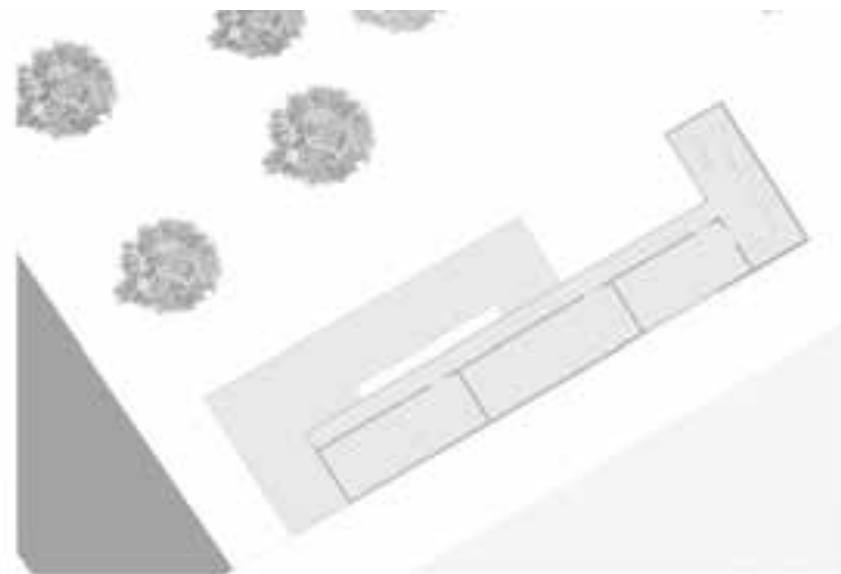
Planta do piso 1 do museu (ilustrações nossas, 2014)
